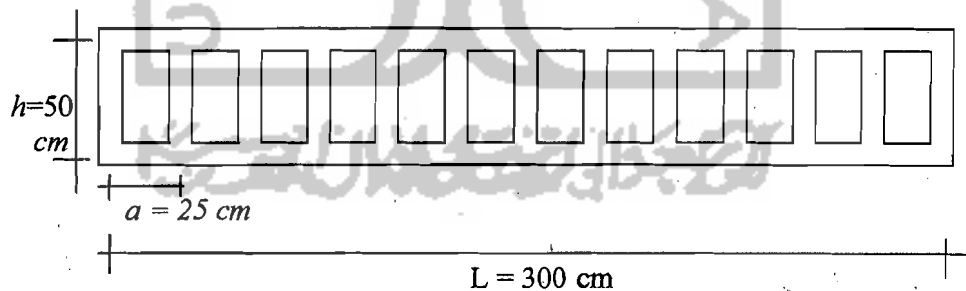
(a) Tampang benda uji balok *Vierendeel
